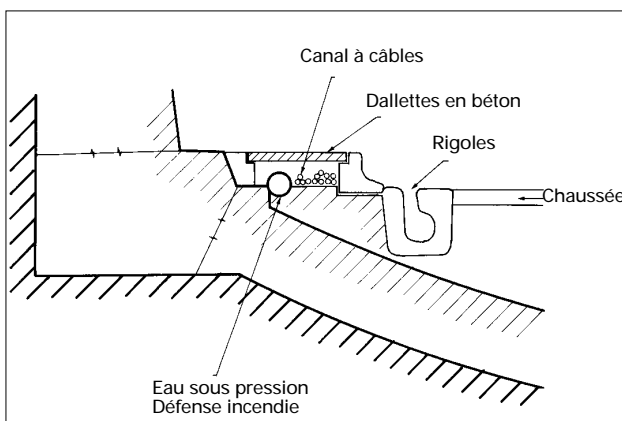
Caniveau à câble pour basse tension et signalisation
